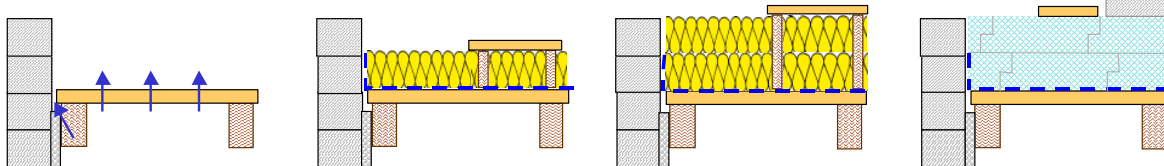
Sichtbalken-, Kehlbalkendecken, Sanierungsvarianten von oben
